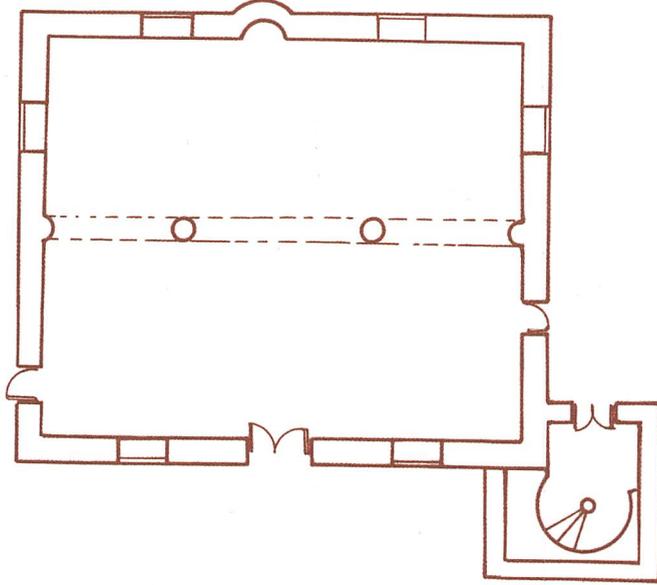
المسقط الأفقى لمسجد وضريح الخراشي بدمنهور
